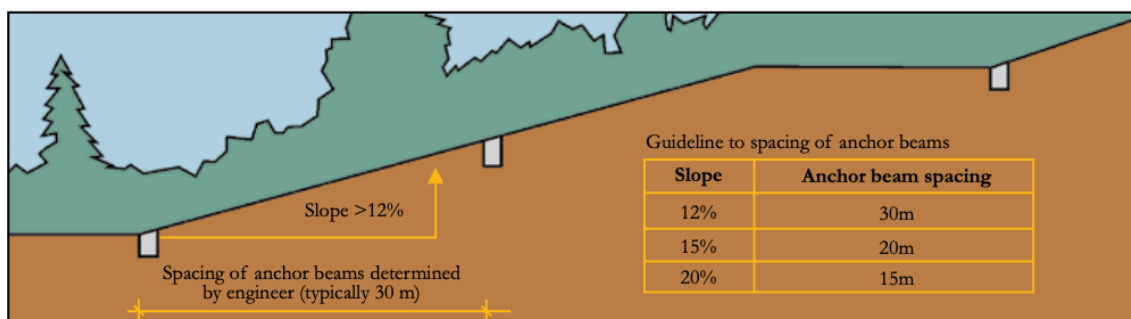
Disposição de vigas de travamento segundo a CMA, SA.
